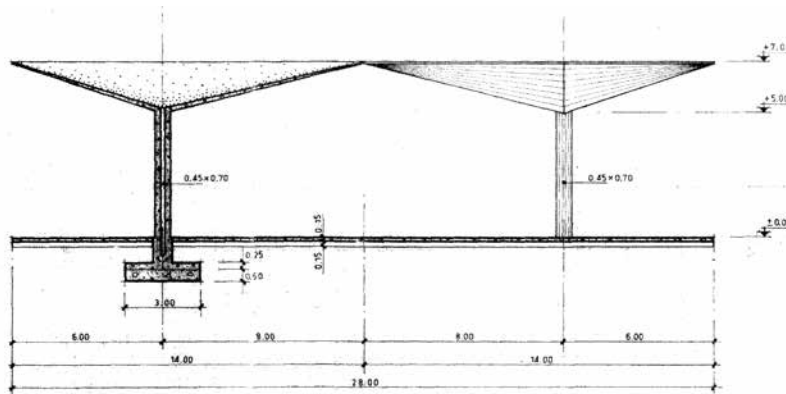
Félix Candela: Sección y alzado del "hypar".
